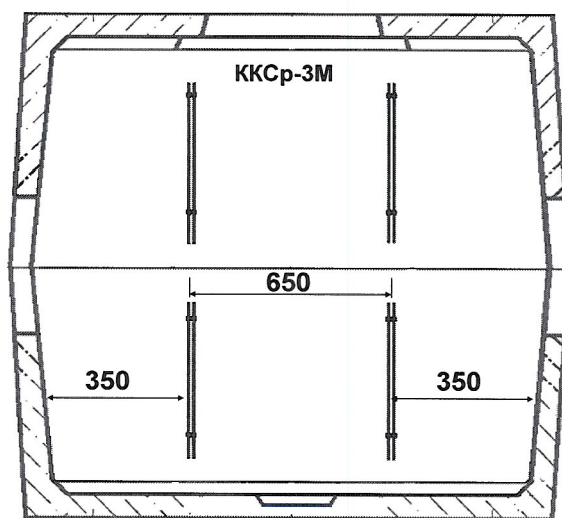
Вид на боковую стену колодца ККСр-3М с размерами.
